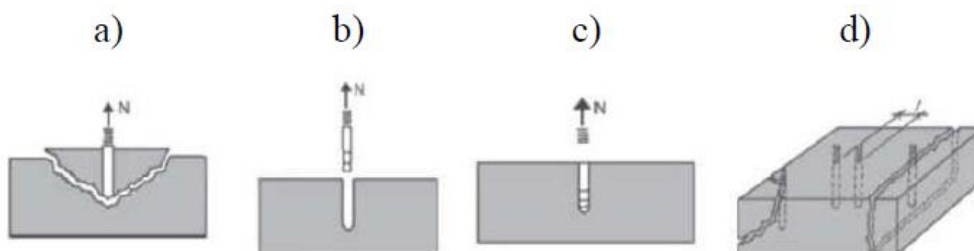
Modes de ruine (cône de béton, arrachement, rupture de l'acier, fissuration du béton)
